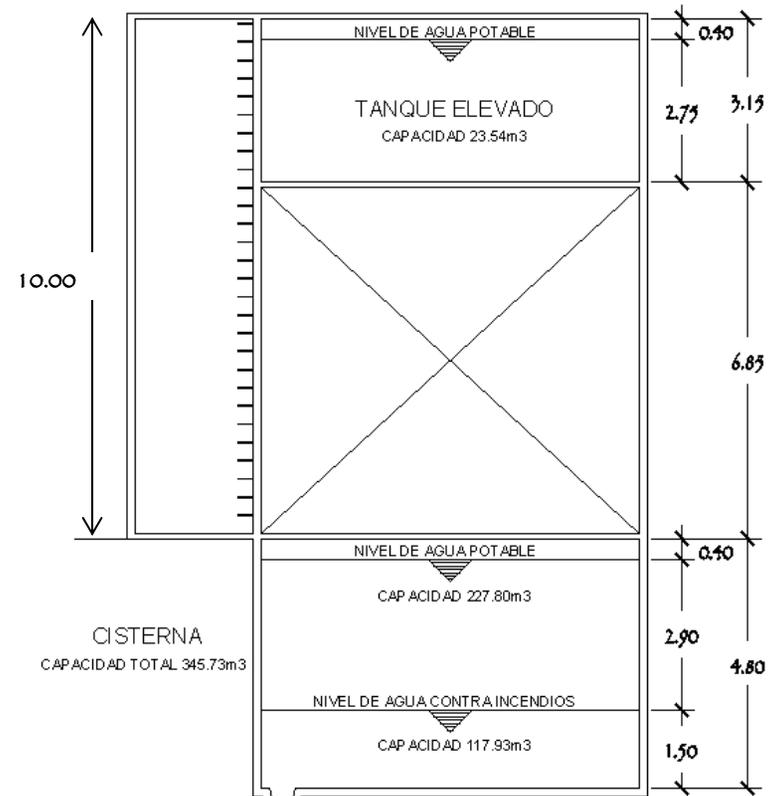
Corte esquemático de la cisterna y el tanque elevado.
